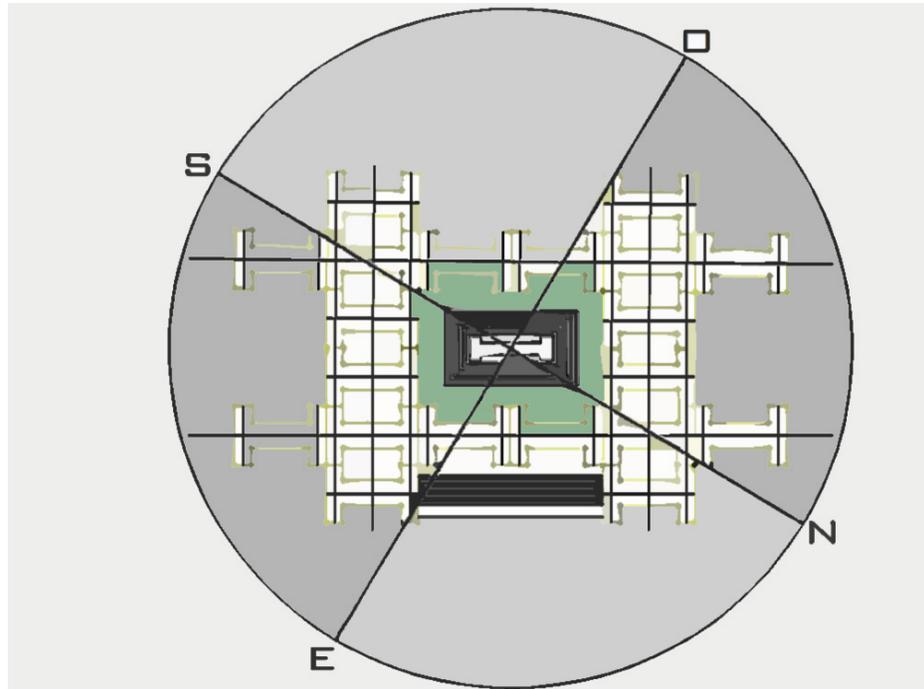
, se muestra la ubicación y la distribución formal de la planta arquitectónica.
